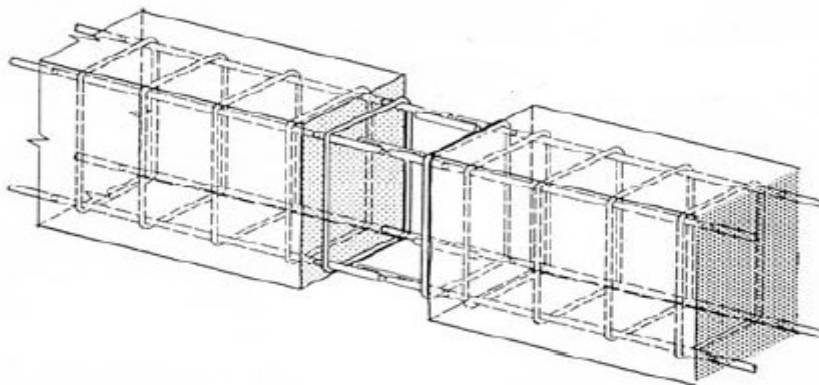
Modelo de ligação viga – viga com recurso a betonagem *in situ* com continuidade.
